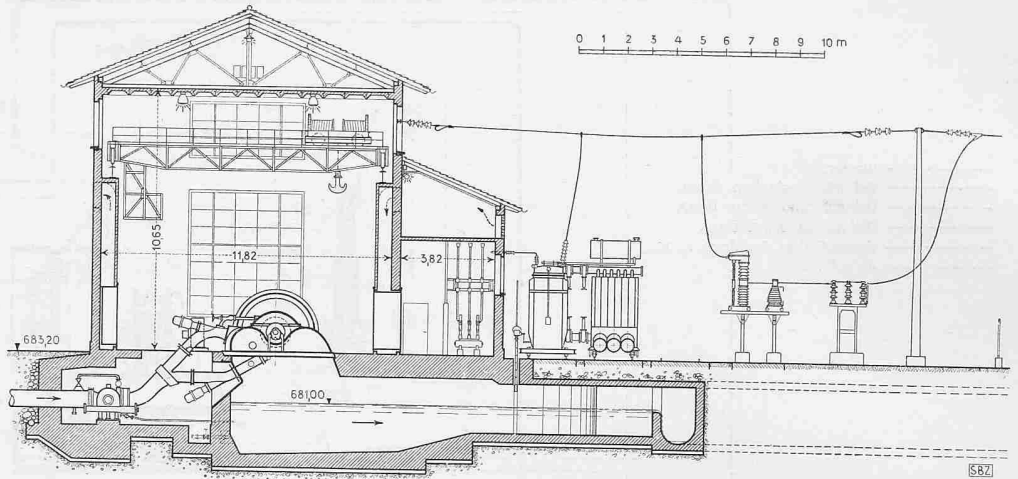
Querschnitt durch das Maschinenhaus und die Freiluft-Schaltanlage, 1:300
